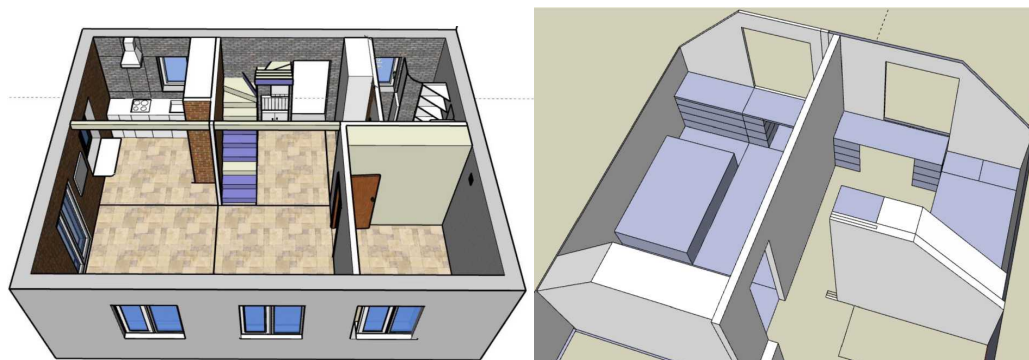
Внутрішнє планування першого та другого поверху будинку
